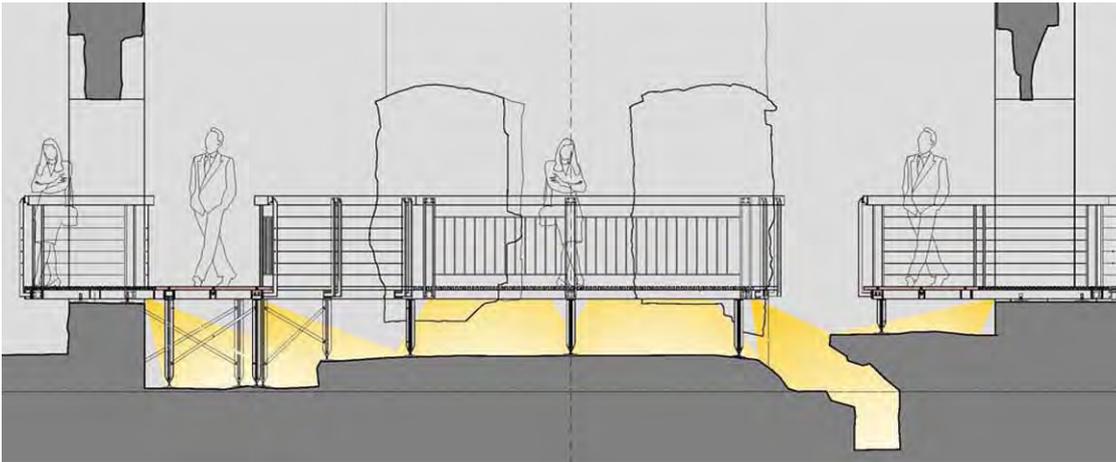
Sala Ottagona con l'inserimento della passerella ponte con attraversamento centrale che si appoggia sulle testate delle murature perimetrali.
